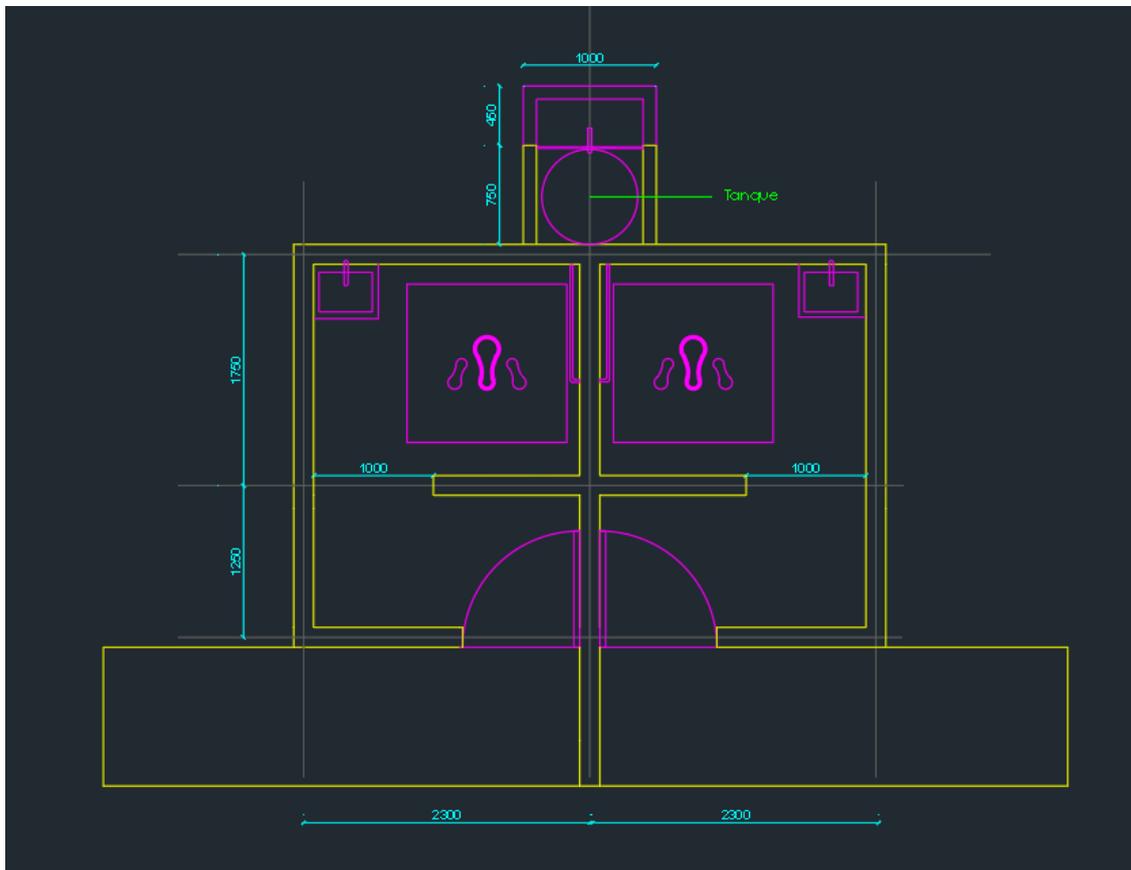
Planta de la infraestructura de los aseos de colegio. Fuente: Propia
